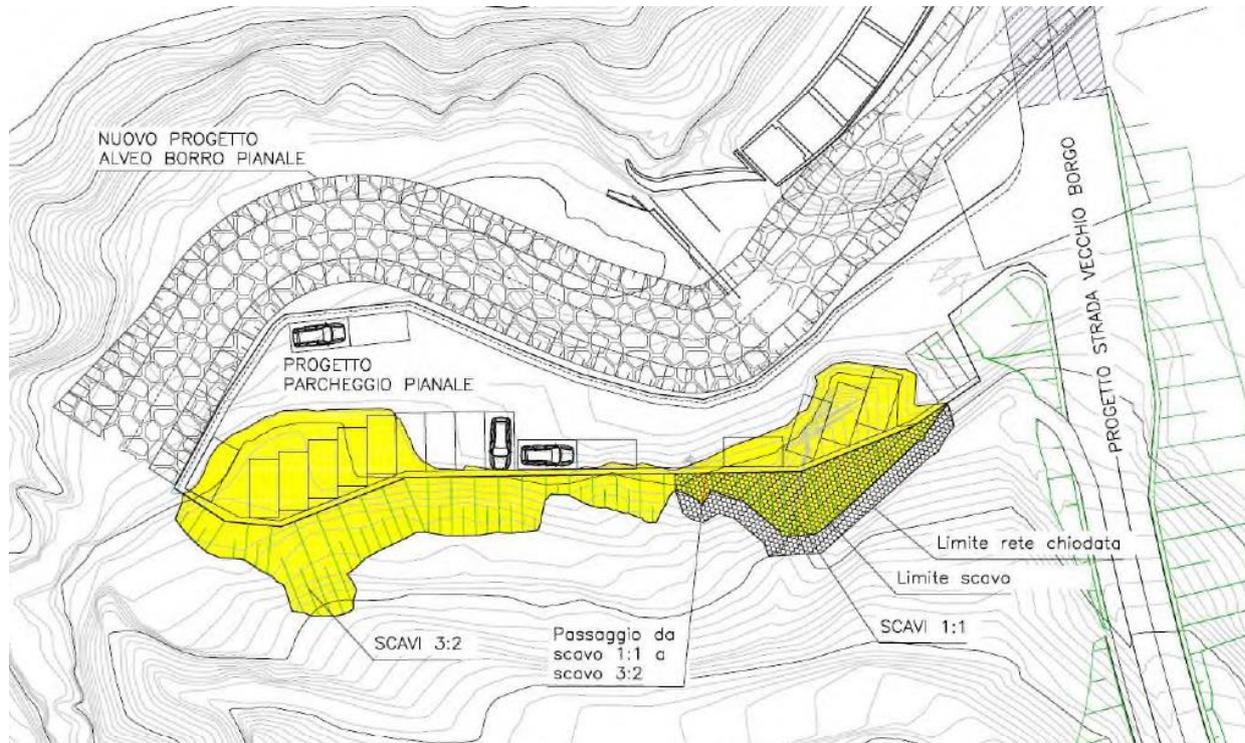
MA13 –Strada Borgo Vecchio: planimetria di progetto.
